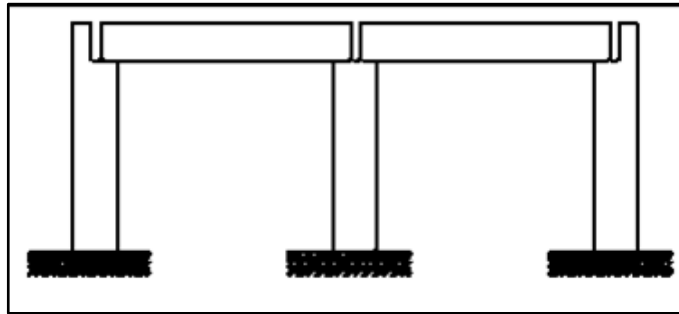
Puente de vigas simplemente apoyadas (Seminario, E., 2004).
